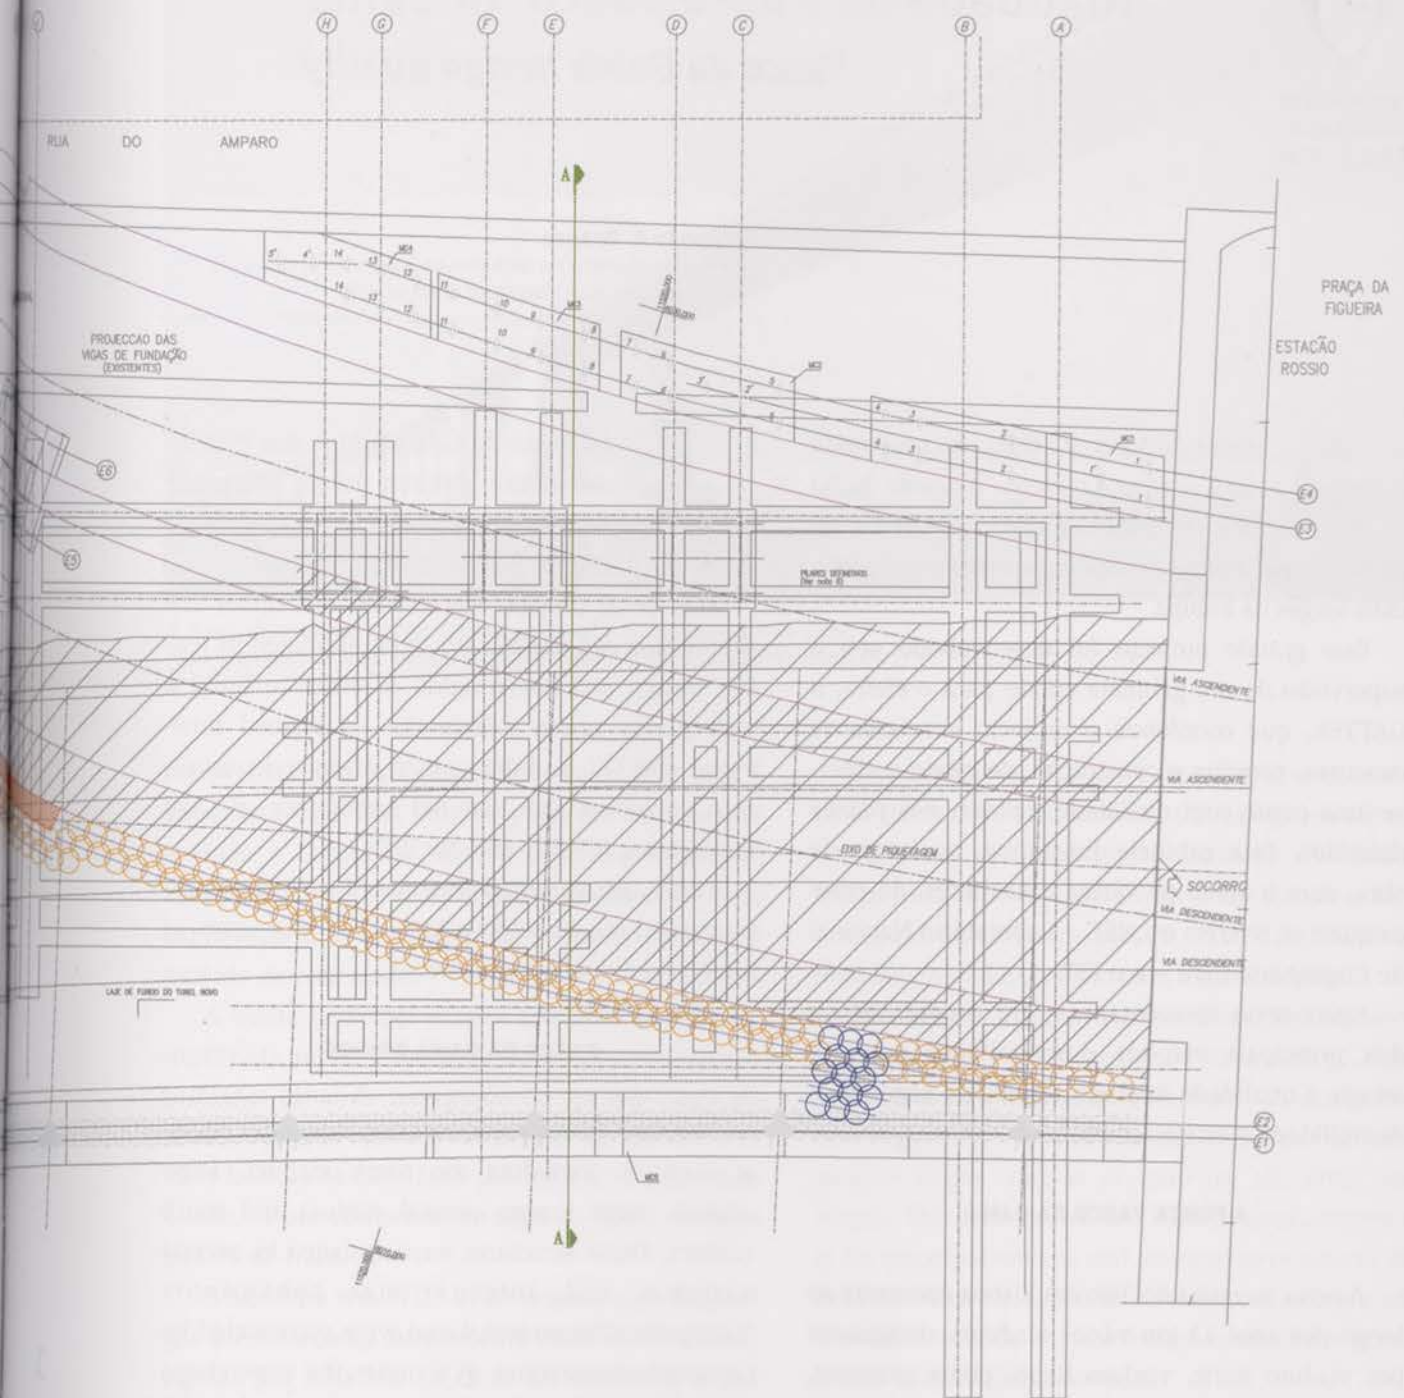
Planta e corte no prédio da pastelaria Suíça, com localização das galerias antiga e nova do metro de Lisboa, e esquema das soluções estruturais adoptadas
